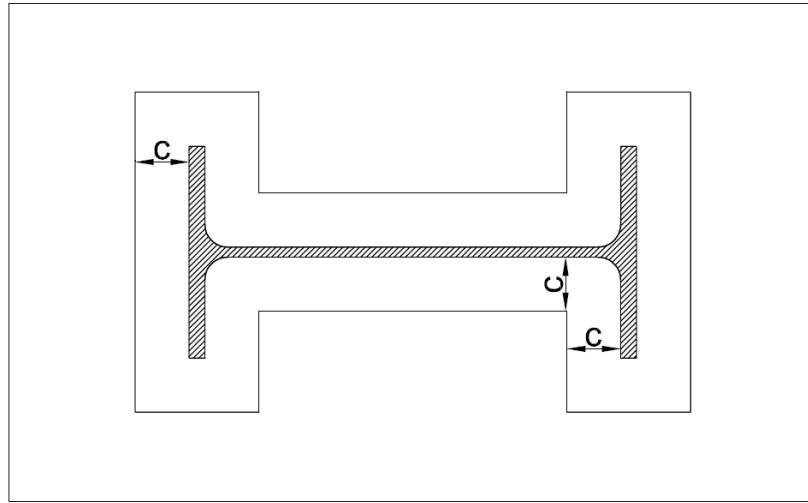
Detalle del área portante de la placa de anclaje.
